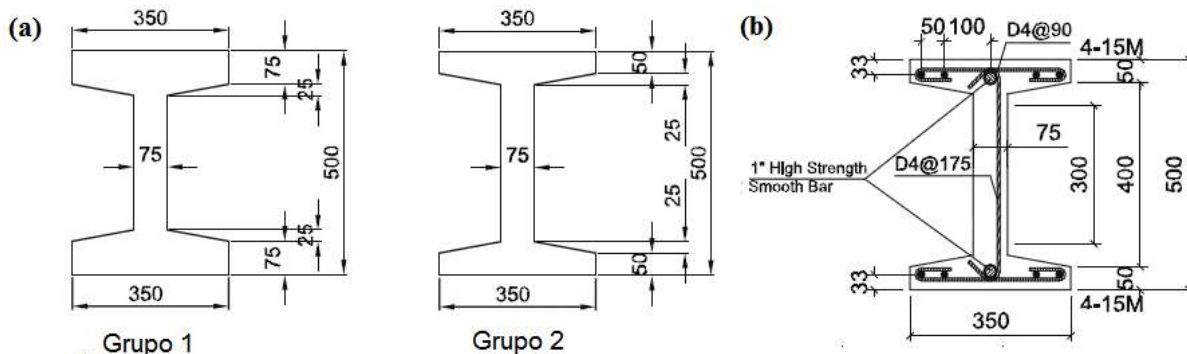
Descrição da secção das vigas testadas por Xie: (a) Dimensões específicas das secções transversais dos dois grupos de vigas; (b) Exemplo do detalhe das armaduras das vigas LB6 a LB9 [36].
